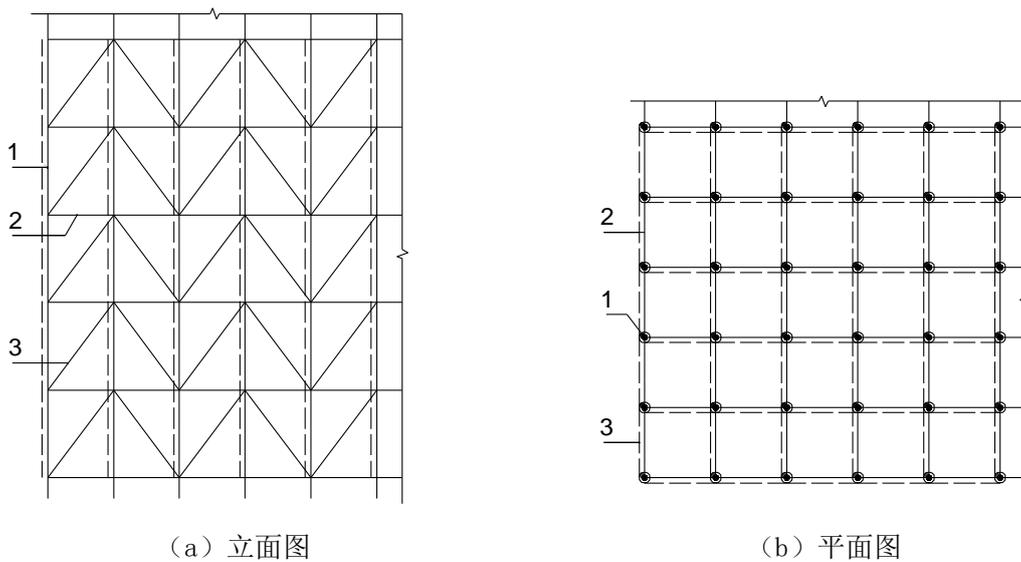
每跨形式竖向斜杆布置示意图
